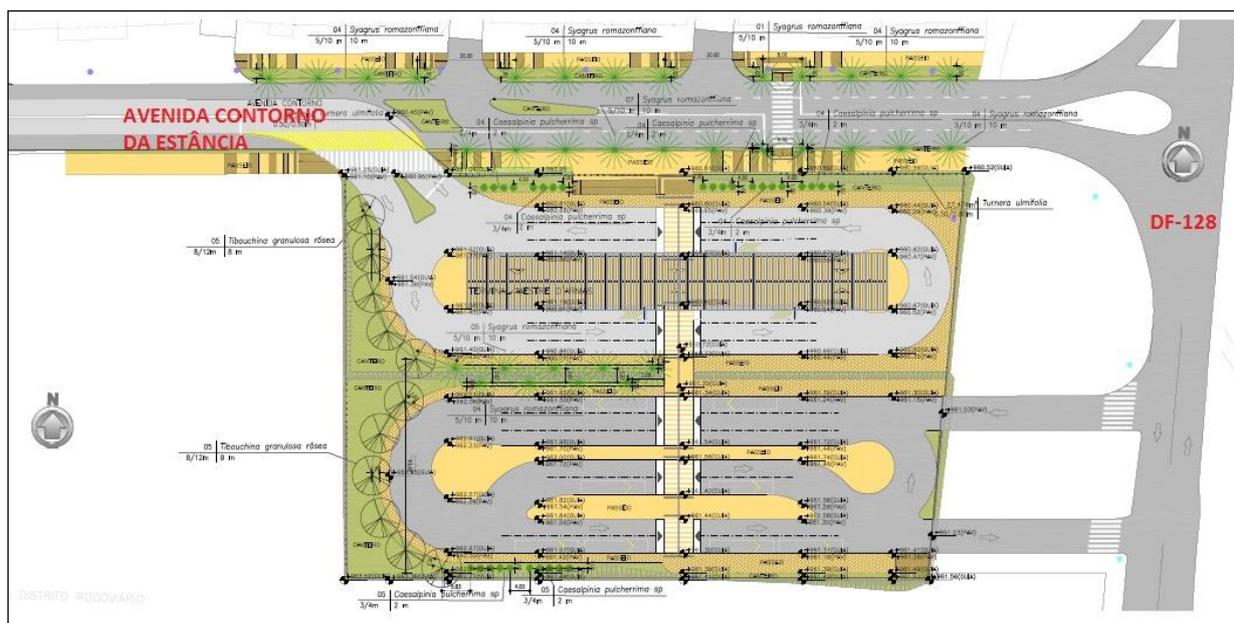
Detalhe da localização do Terminal Mestre D’armas (Consórcio DF Interligado)
